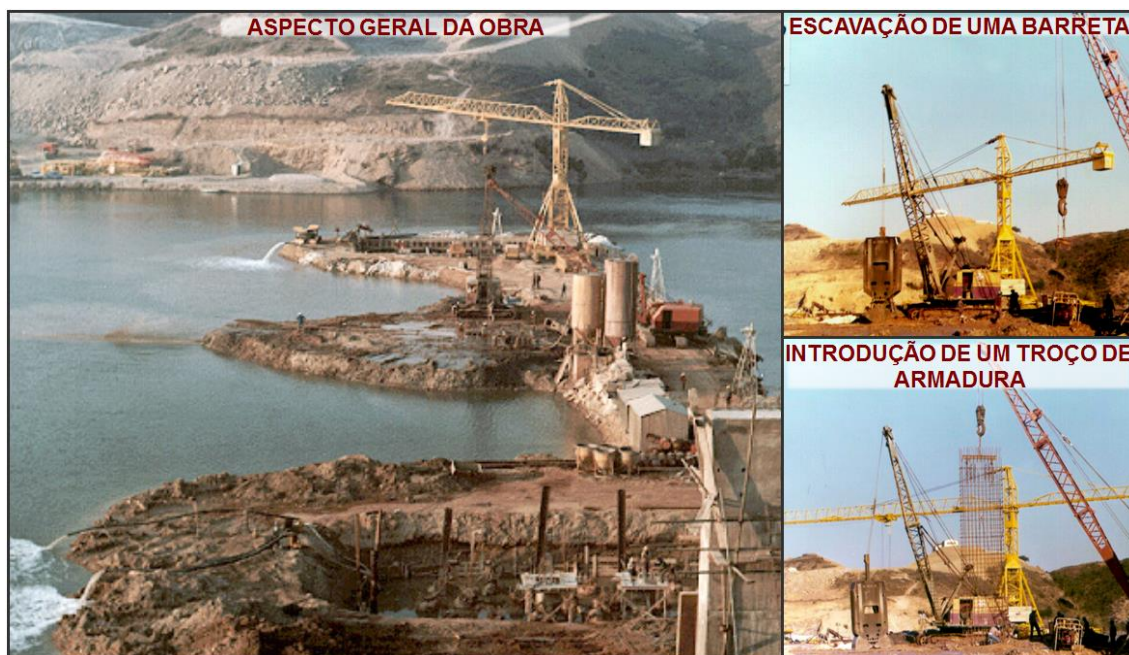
Aspeto geral da obra e pormenores de algumas das fases de execução das barretas do pilar P3
